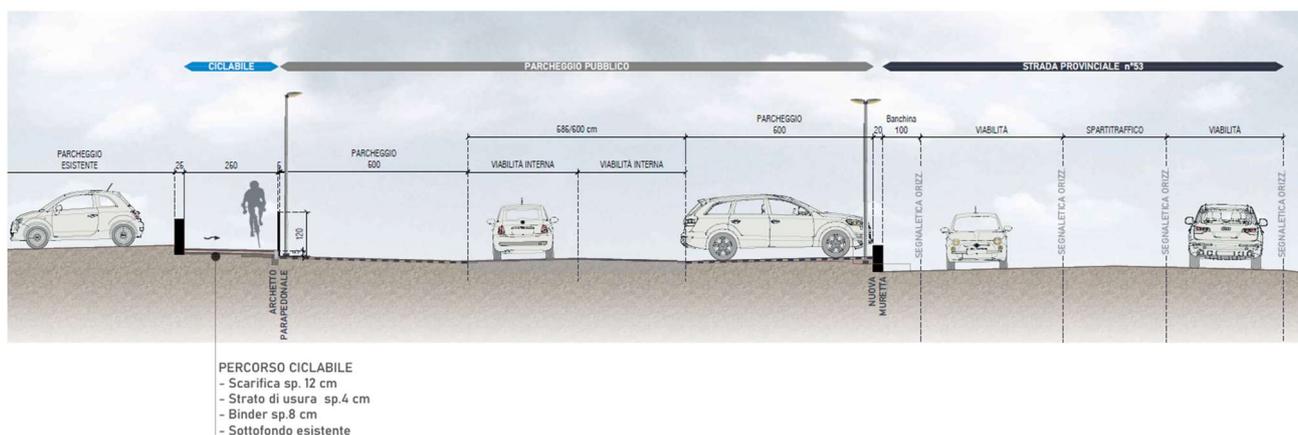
Sezione tipo su area parcheggio pubblico con pavimentazione in conglomerato bituminoso drenante semiaperto
